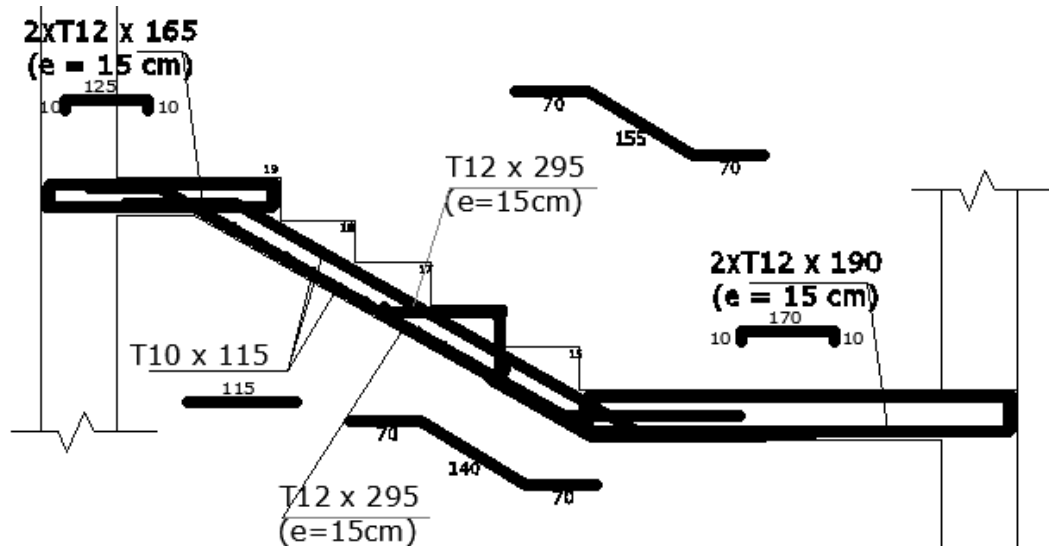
Ferrailage de coupe B-B (escalier 3)
